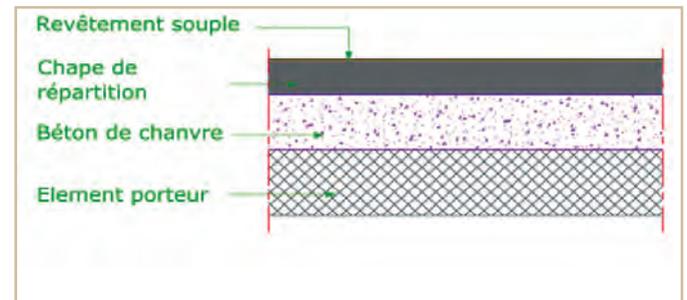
Schéma simplifié de revêtement souple sur chape sur forme de béton de chanvre
